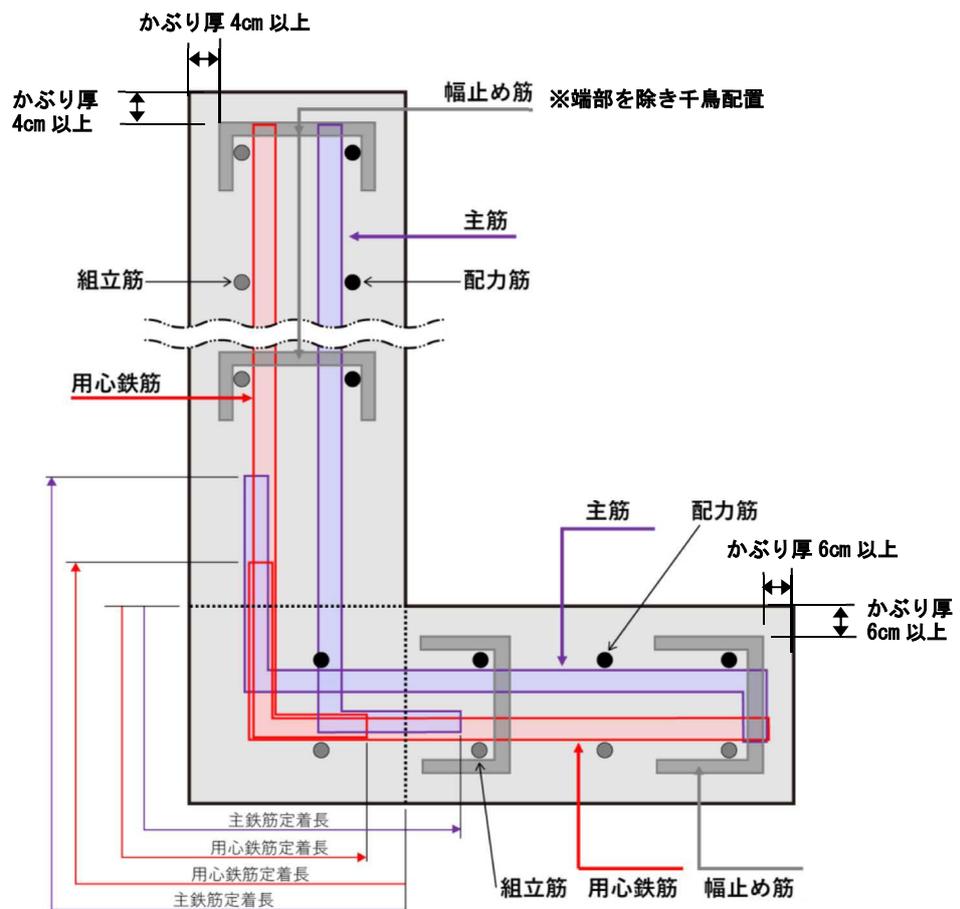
(14)-2 L型鉄筋コンクリート擁壁の配筋要領
